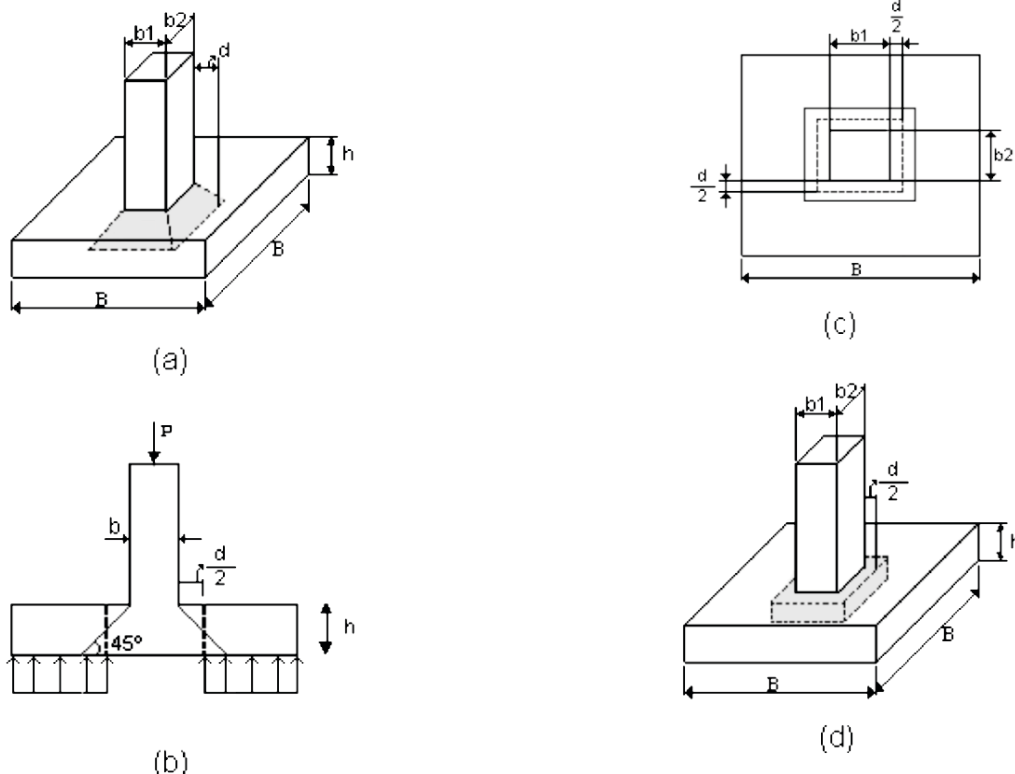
A CORTANTE BIDIRECCIONAL EN ZAPATA QUE SOPORTA COLUMNA, PEDESTAL O MURO DE CONCRETO
